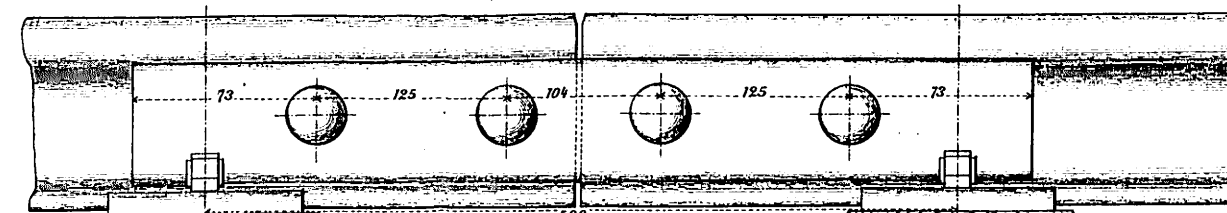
Grundriss des Stosses. (1:5 d. nat. Gr.)
